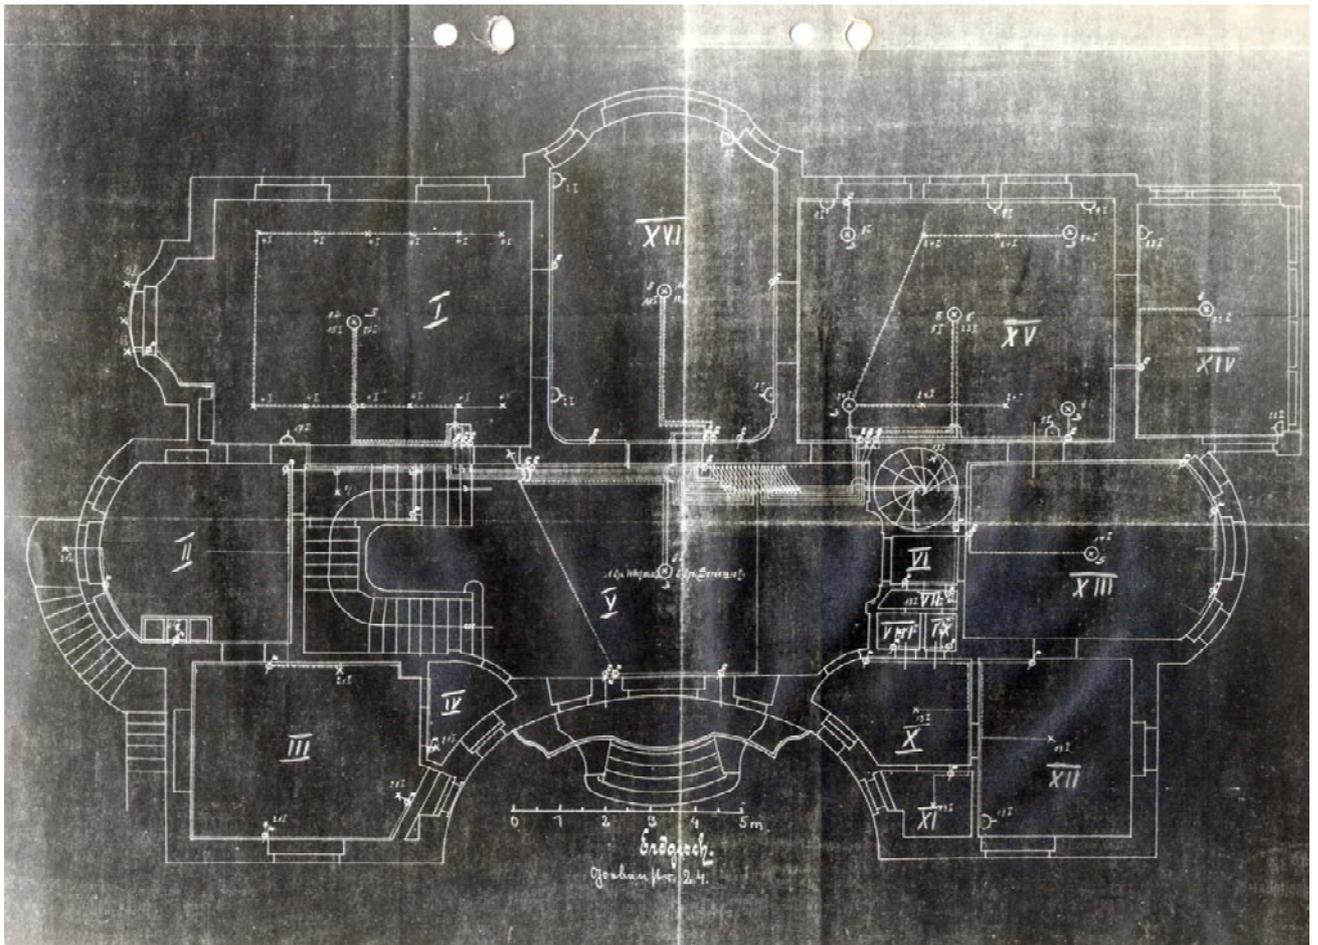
H. Plange, Haus Robert Wichelhaus, 1907, Grundriss Erdgeschoss vor 1948
